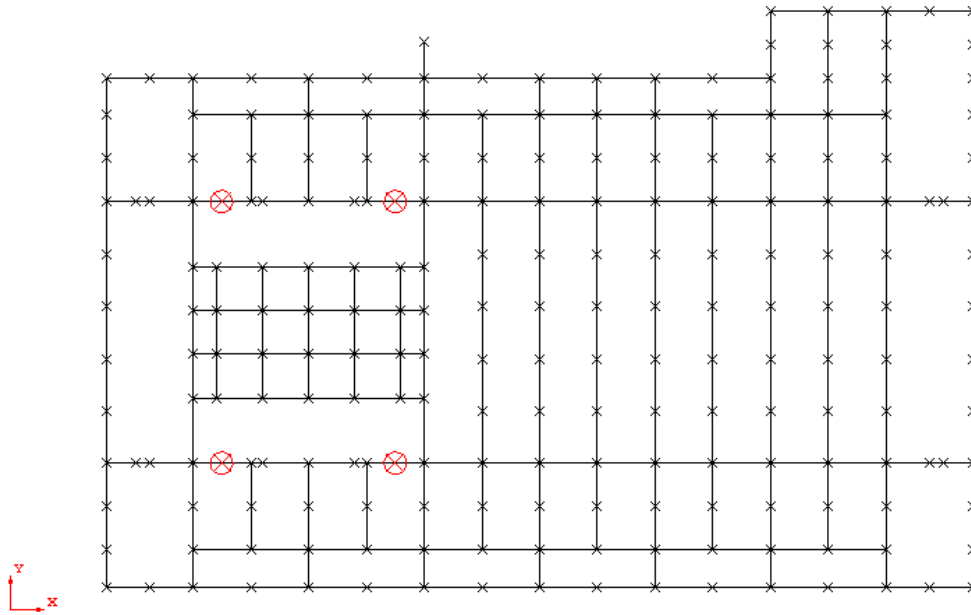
TORRE DE PERFORACIÓN – TUBERÍAS – APLICACIÓN DE CARGAS CUBIERTA SUPERIOR.
